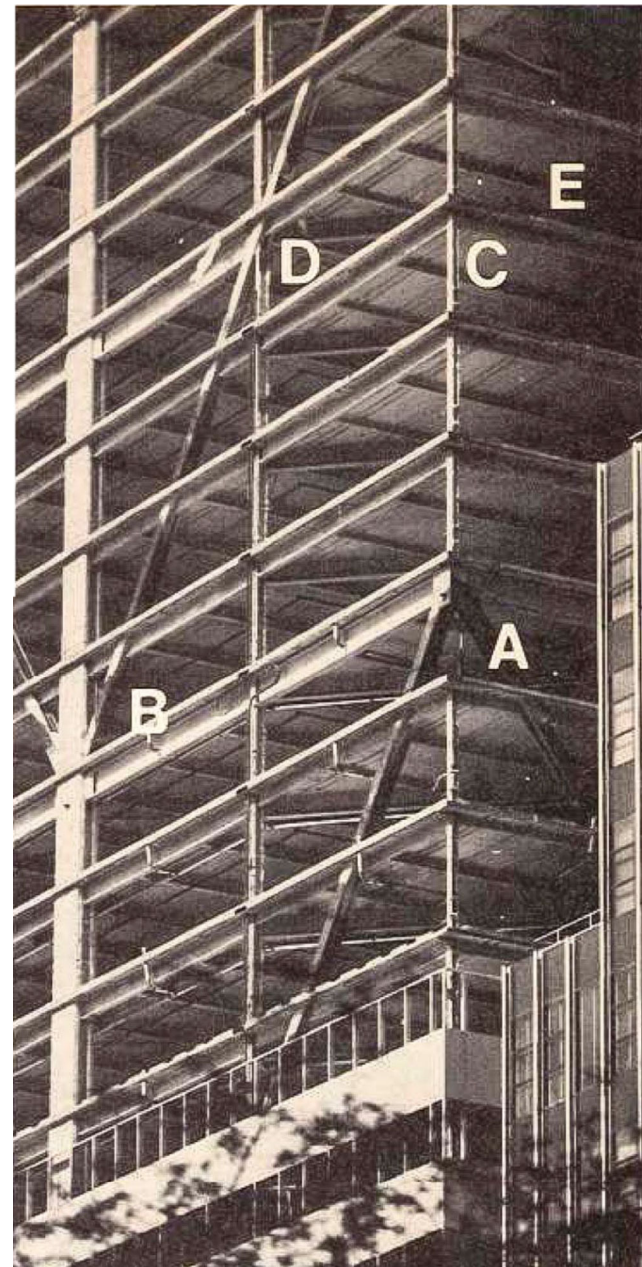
Detalle de la estructura. Desde el interior de la torre del Citicorp, la visión de la estructura varía dependiendo de la planta en la que se encuentre el usuario en el módulo estructural. Los soportes laterales se omiten en la octava planta de cada módulo, donde las diagonales se unen (A), canalizando la acumulación de la carga gravitatoria de las plantas superiores a los chevrones invertidos. La gran esbeltez de los pilares de las esquinas (C) es posible gracias a las vigas diagonales de cada forjado, ya que conectan los soportes intermedios del alzado y provocan que los pilares laterales asuman áreas tributarias pequeñas. En la base de los módulos, los soportes «mástil» centrales se unen a los chevrones invertidos en el eje de simetría de cada fachada (B). Por otro lado, en el cuarto nivel de cada módulo, las diagonales intersecan con los soportes intermedios (D), los cuales podrían eliminarse en el nivel inferior, al igual que los soportes laterales en la octava planta. Sin embargo, se mantienen para evitar fenómenos de pandeo en las diagonales. La idea de prolongar el espacio de oficinas sin pilares intermedios, se enfatiza al observar la vista panorámica más abajo recogida (E).
